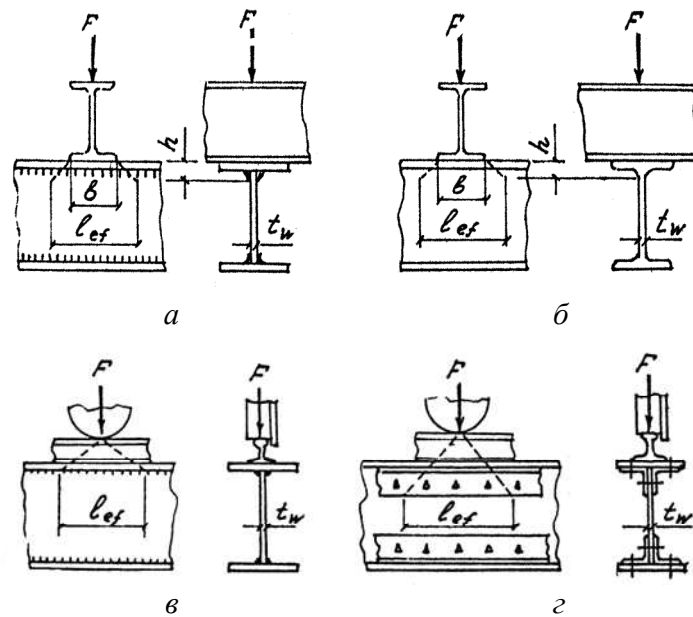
Схема передачі зосередженого навантаження на стінку балки:
